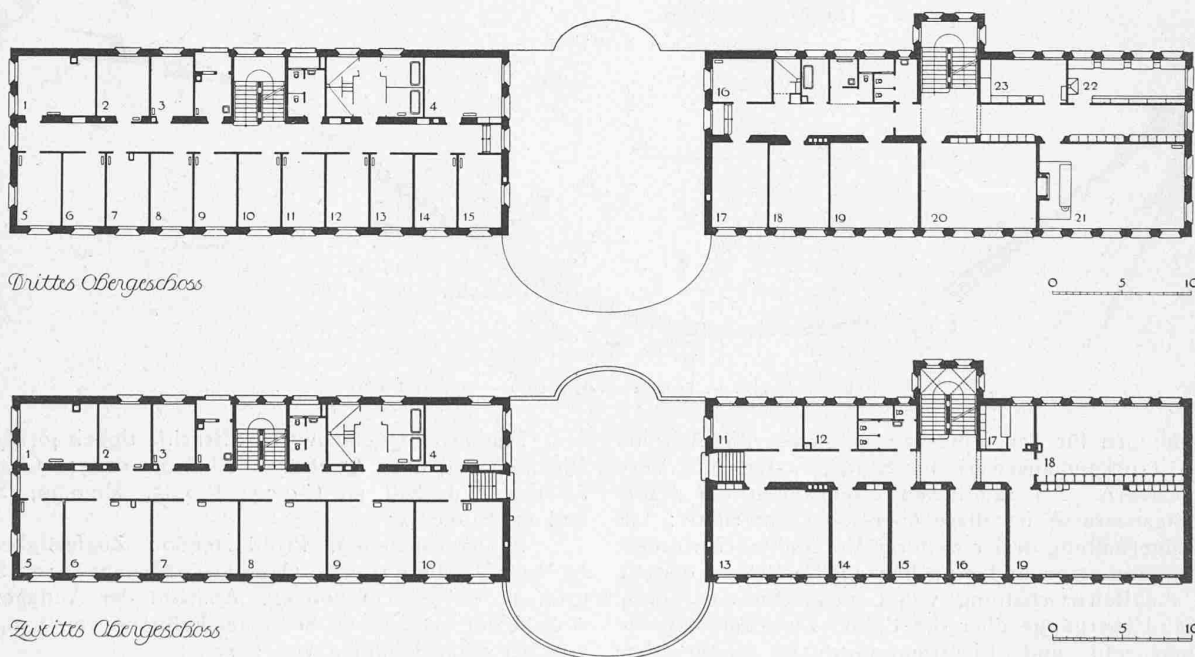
und 6. Grundrisse des Hochalpinen Töchterinstituts Fetan im Unterengadin. — Masstab 1:500.
